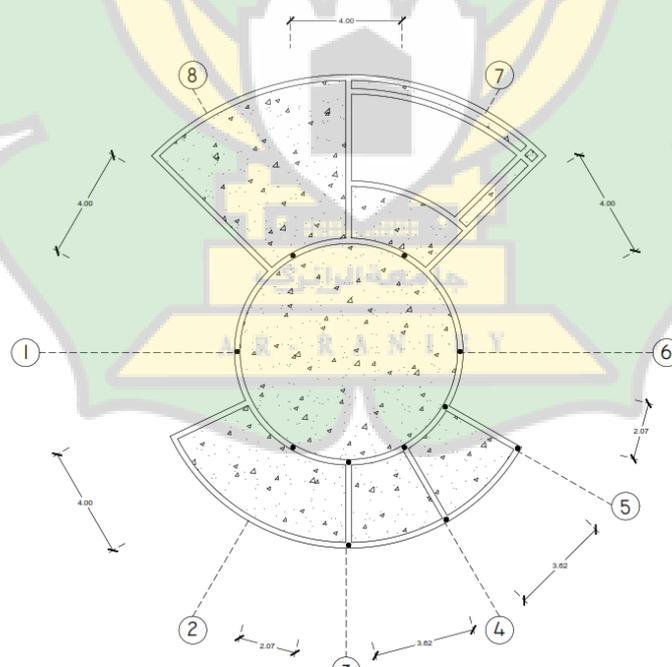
Denah Plat Lantai 1 Lobby dan Pengelola
